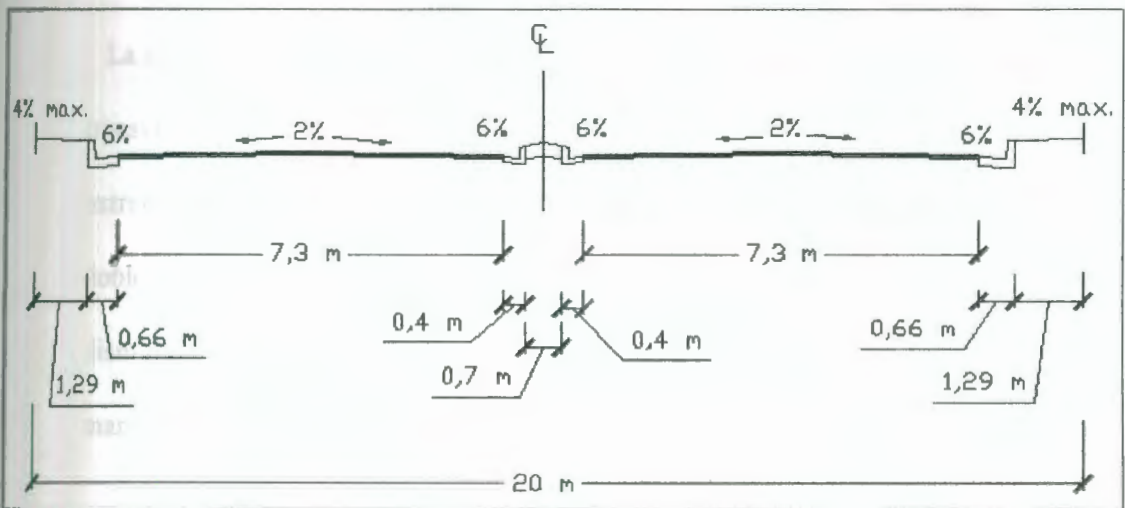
ALTERNATIVA DE SECCIÓN TIPO # 2
